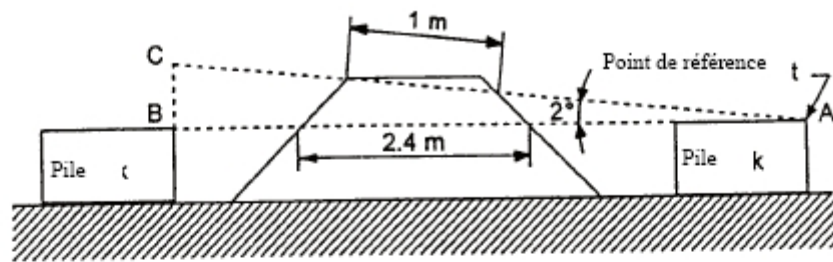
III. Détermination de la hauteur d'un merlon sur un terrain incliné
